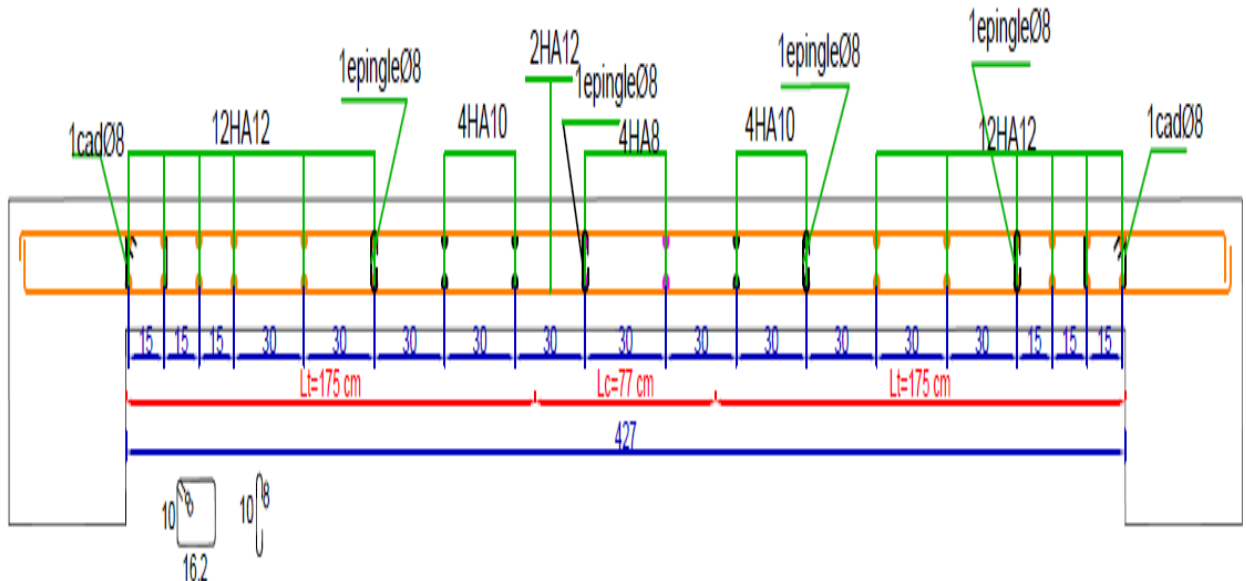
Schéma de ferrailage (section transversale) du voile Vy4 au niveau du RDC
